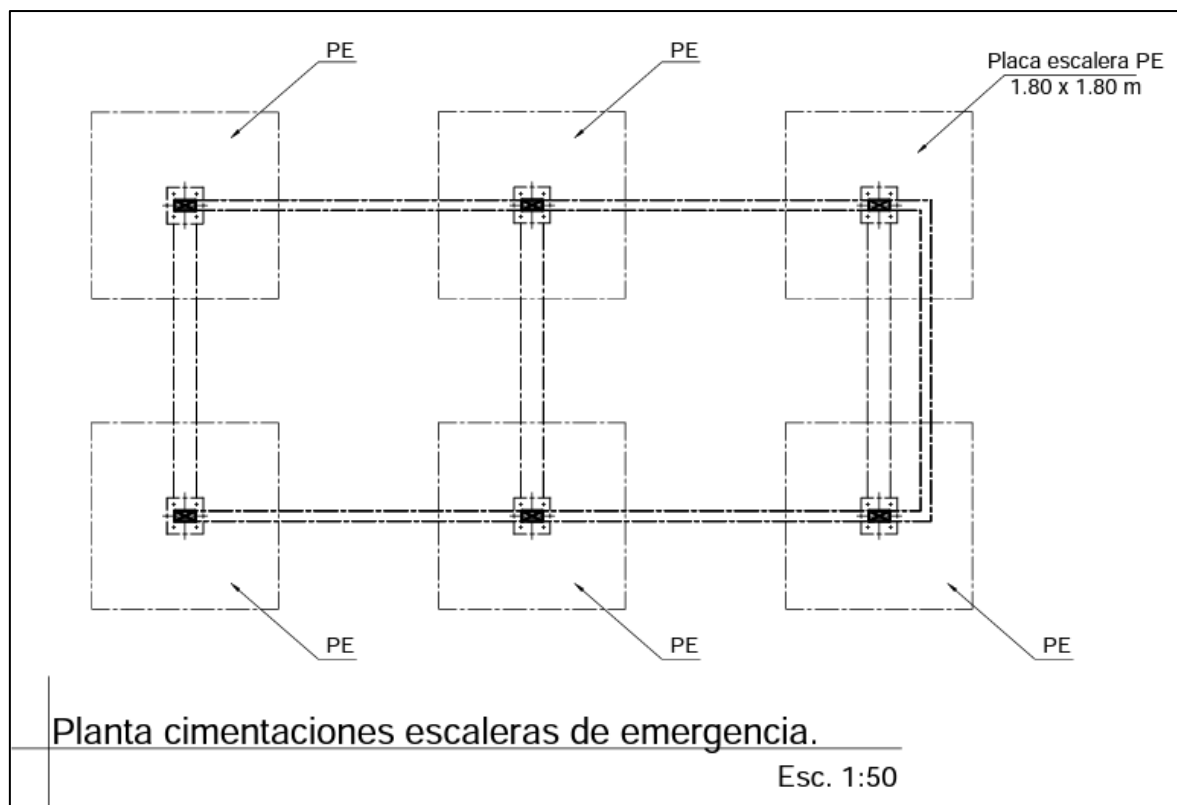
Planta de cimentaciones para las escaleras de emergencia
